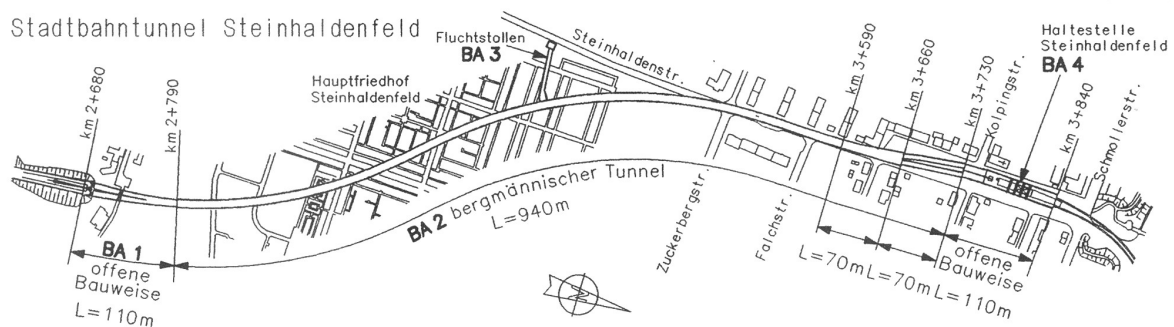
Lageplan Baumaßnahme Stadtbahntunnel Steinhaldenfeld [1]
